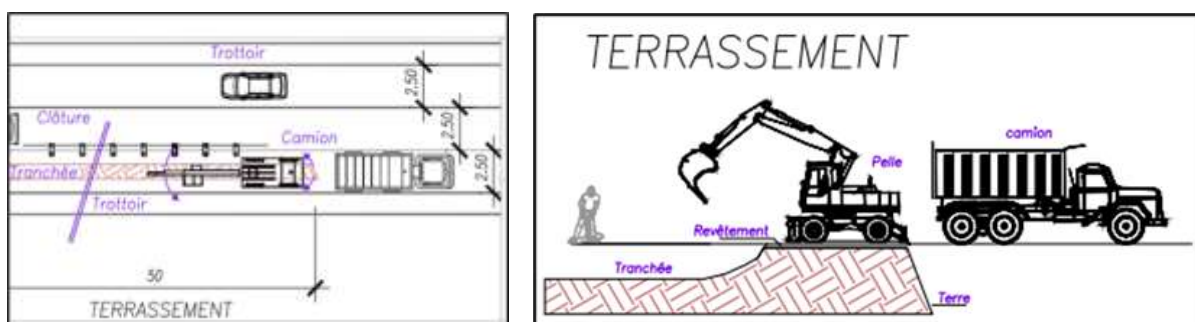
Vue du dessus d'un poste de terrassement (gauche) et Vue en coupe d'un poste de terrassement (droite)
